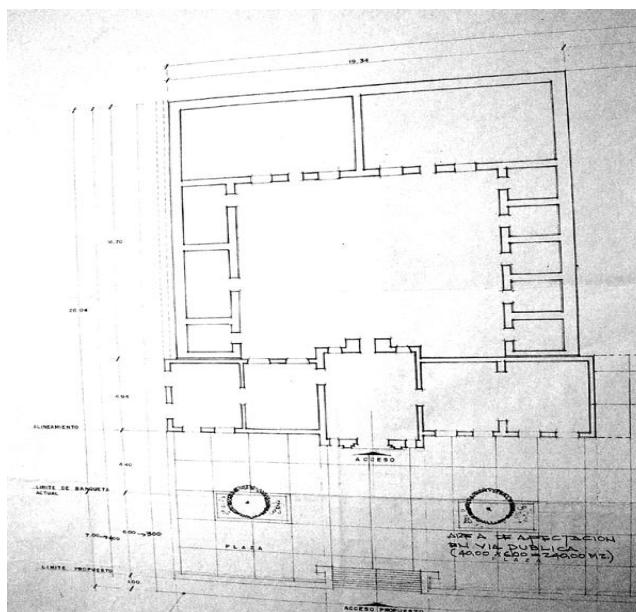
Vista de planta de la Cárcel de Cananea. Planoteca del AGES.
